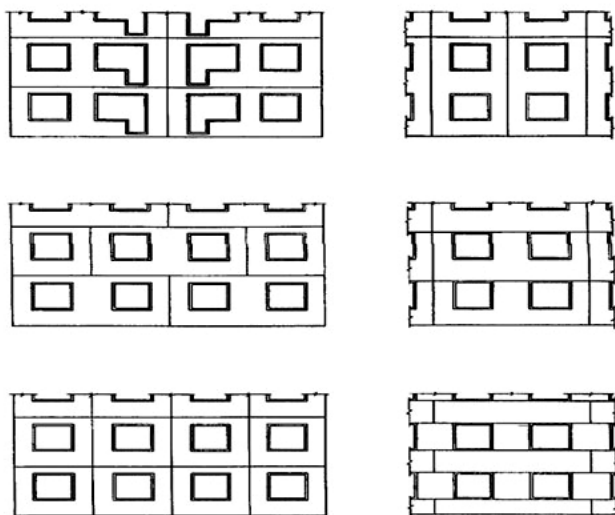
Системы разрезки наружных стен панельных зданий
